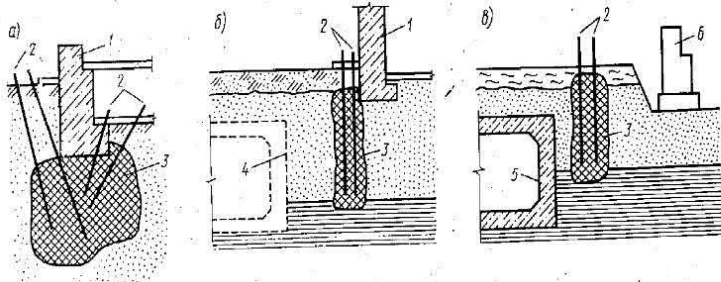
Схемы закрепления методом силикатизации оснований фундаментов (а), защиты фундаментов зданий при строительстве подземных сооружений (б), при возведении зданий (б'):
